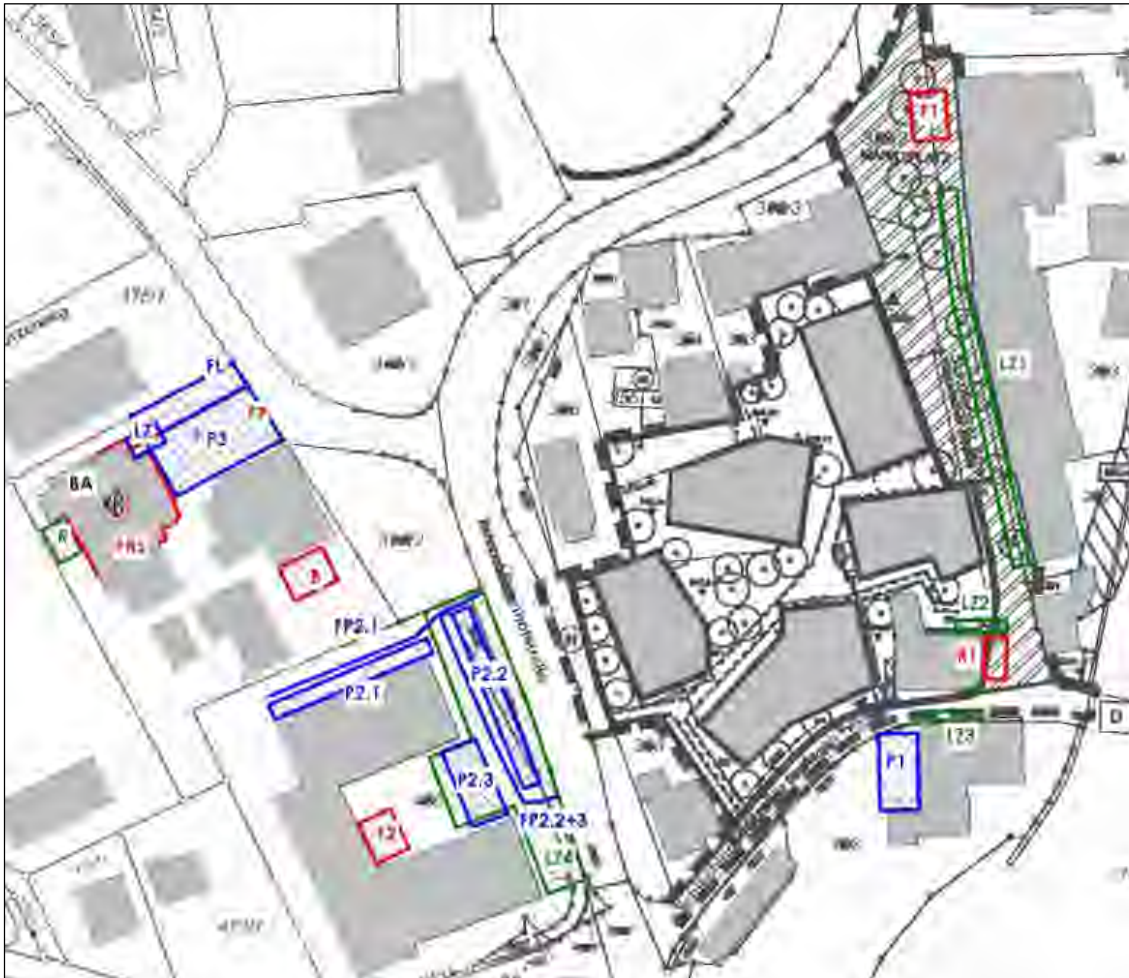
Lageplan mit Darstellung der relevanten Schallquellen
